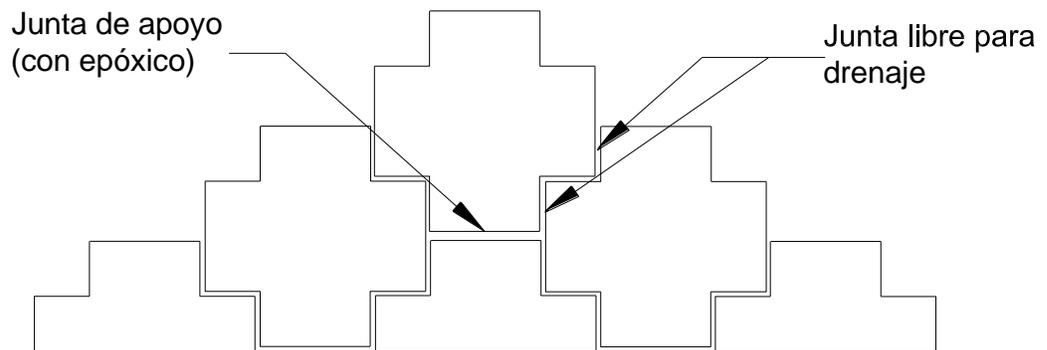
Ubicación de las juntas para drenaje en muros de Tierra armada
